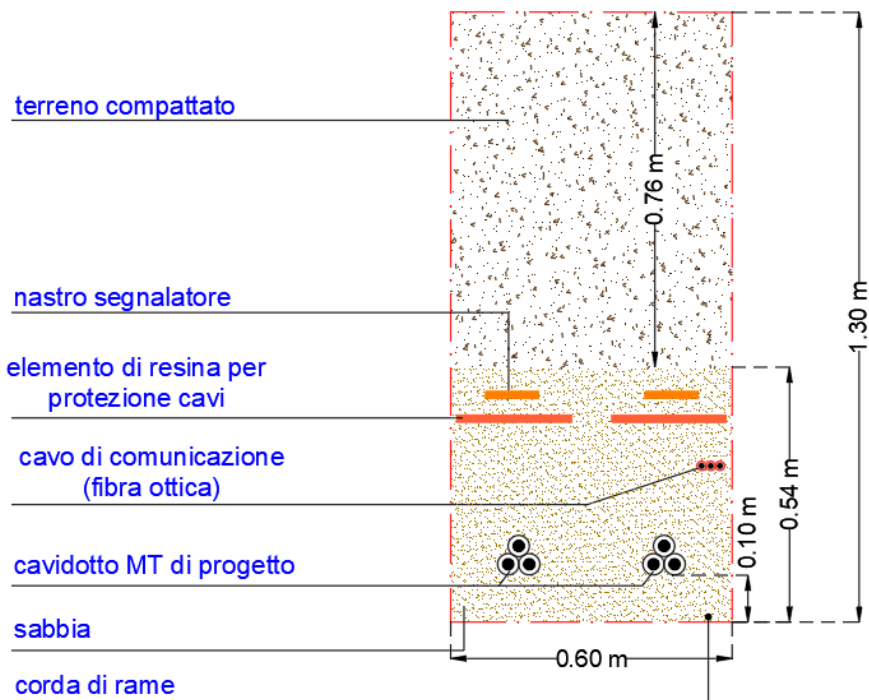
Sezione Cavidotto Doppia Terna su Terreno
